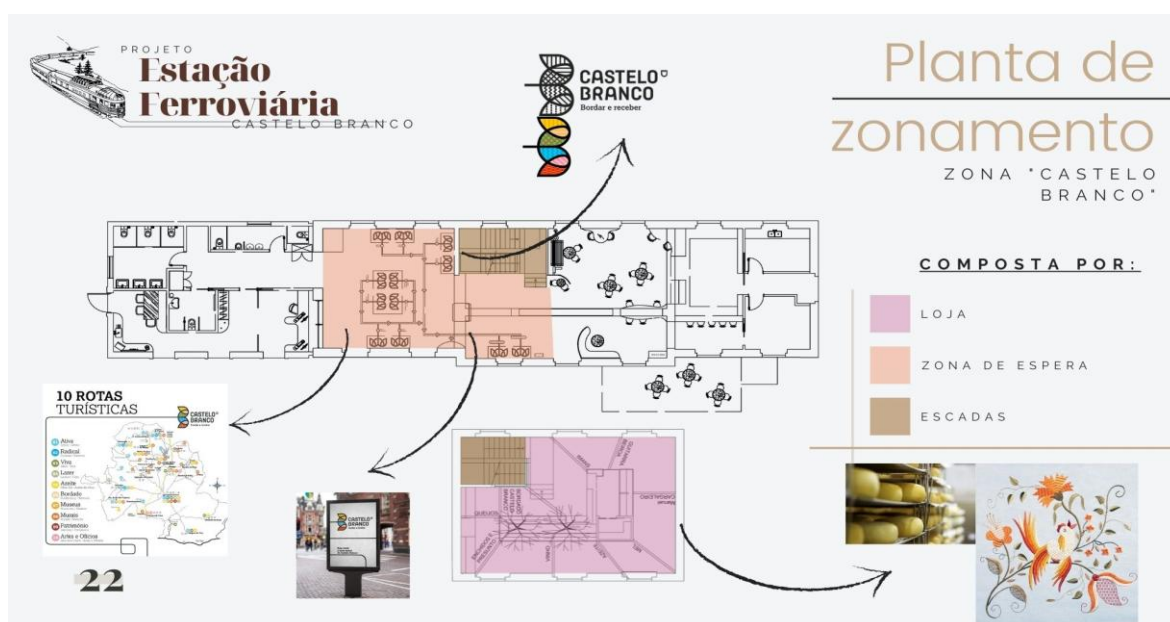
Planta de Zonamentos colorida da zona de “Castelo Branco”
